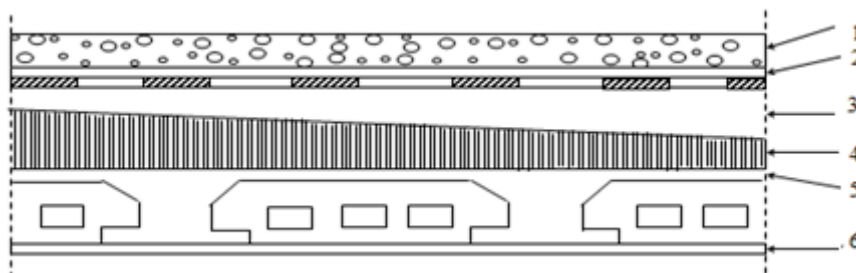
Coupe verticale du plancher terrasse à corps creux.
